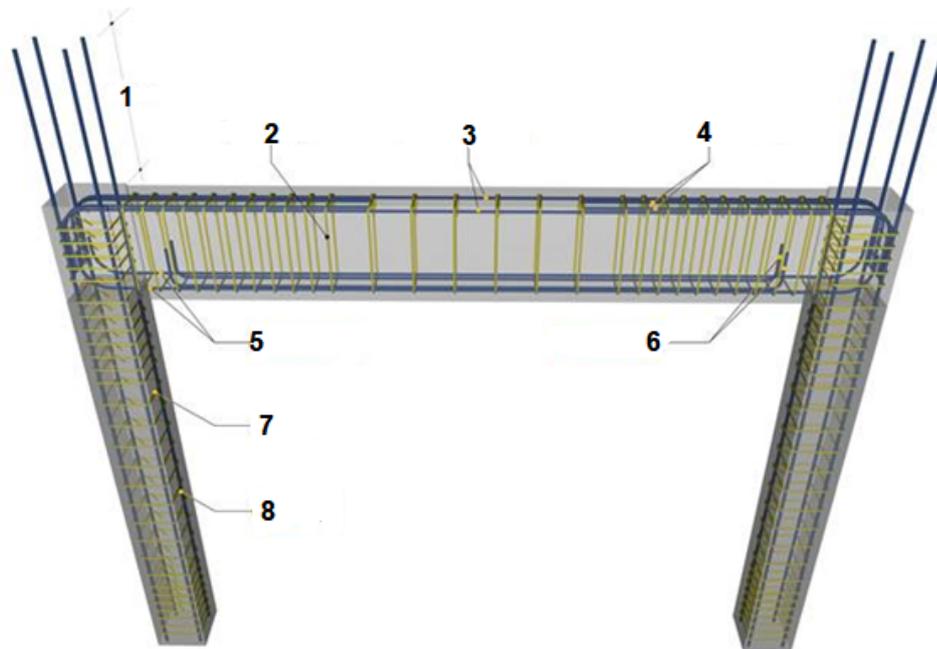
Створення традиційної арматурної схеми для балки в Tekla Structures
